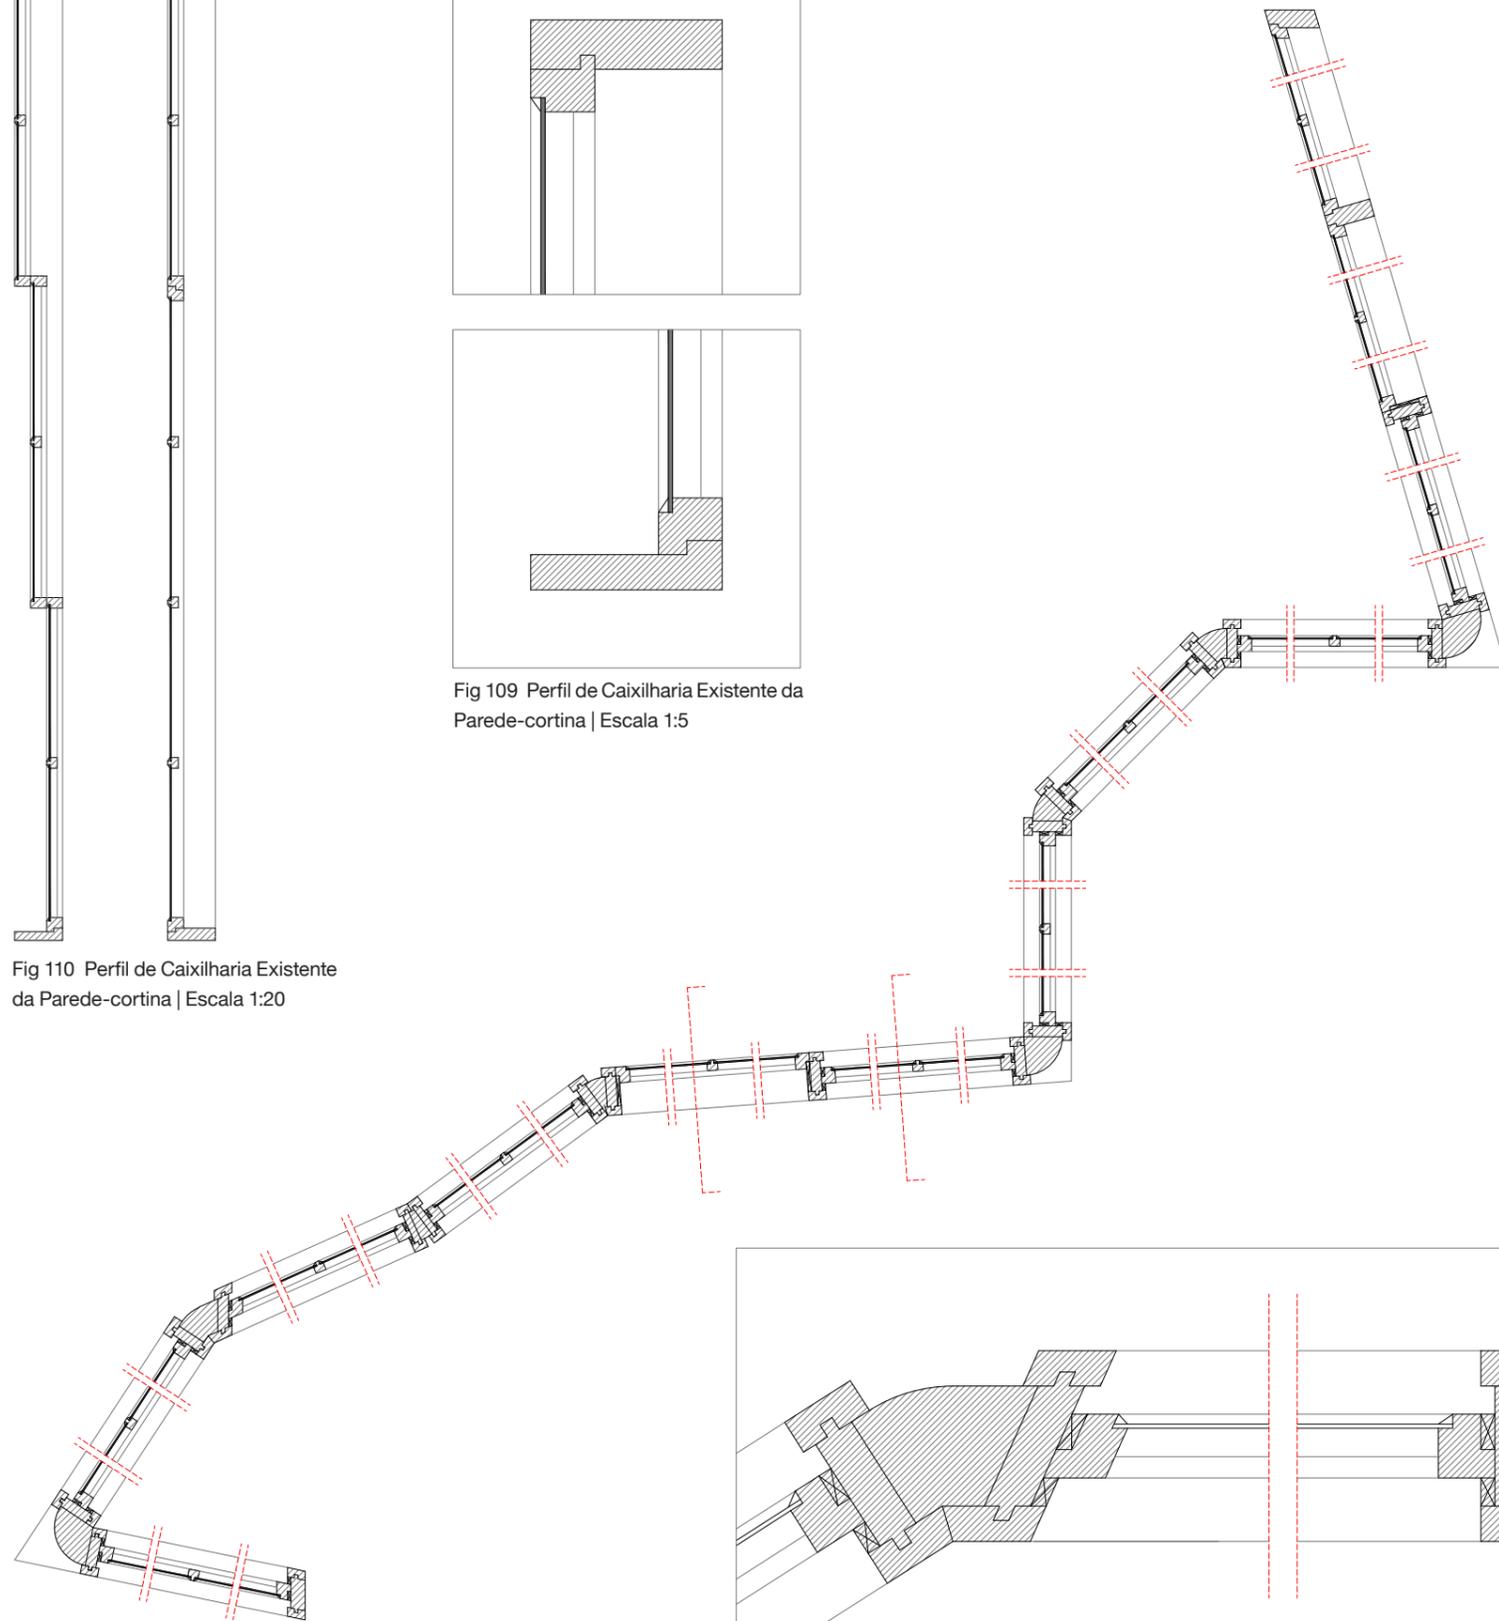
Planta de Caixilharia Existente da Parede-cortina | Escala 1:20
